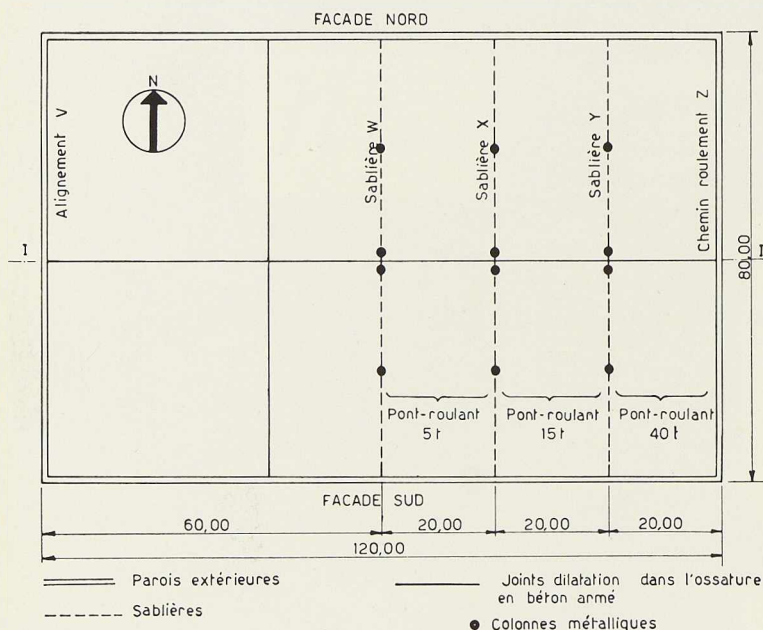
Plan du bâtiment A du Palais des Expositions de Charleroi.
